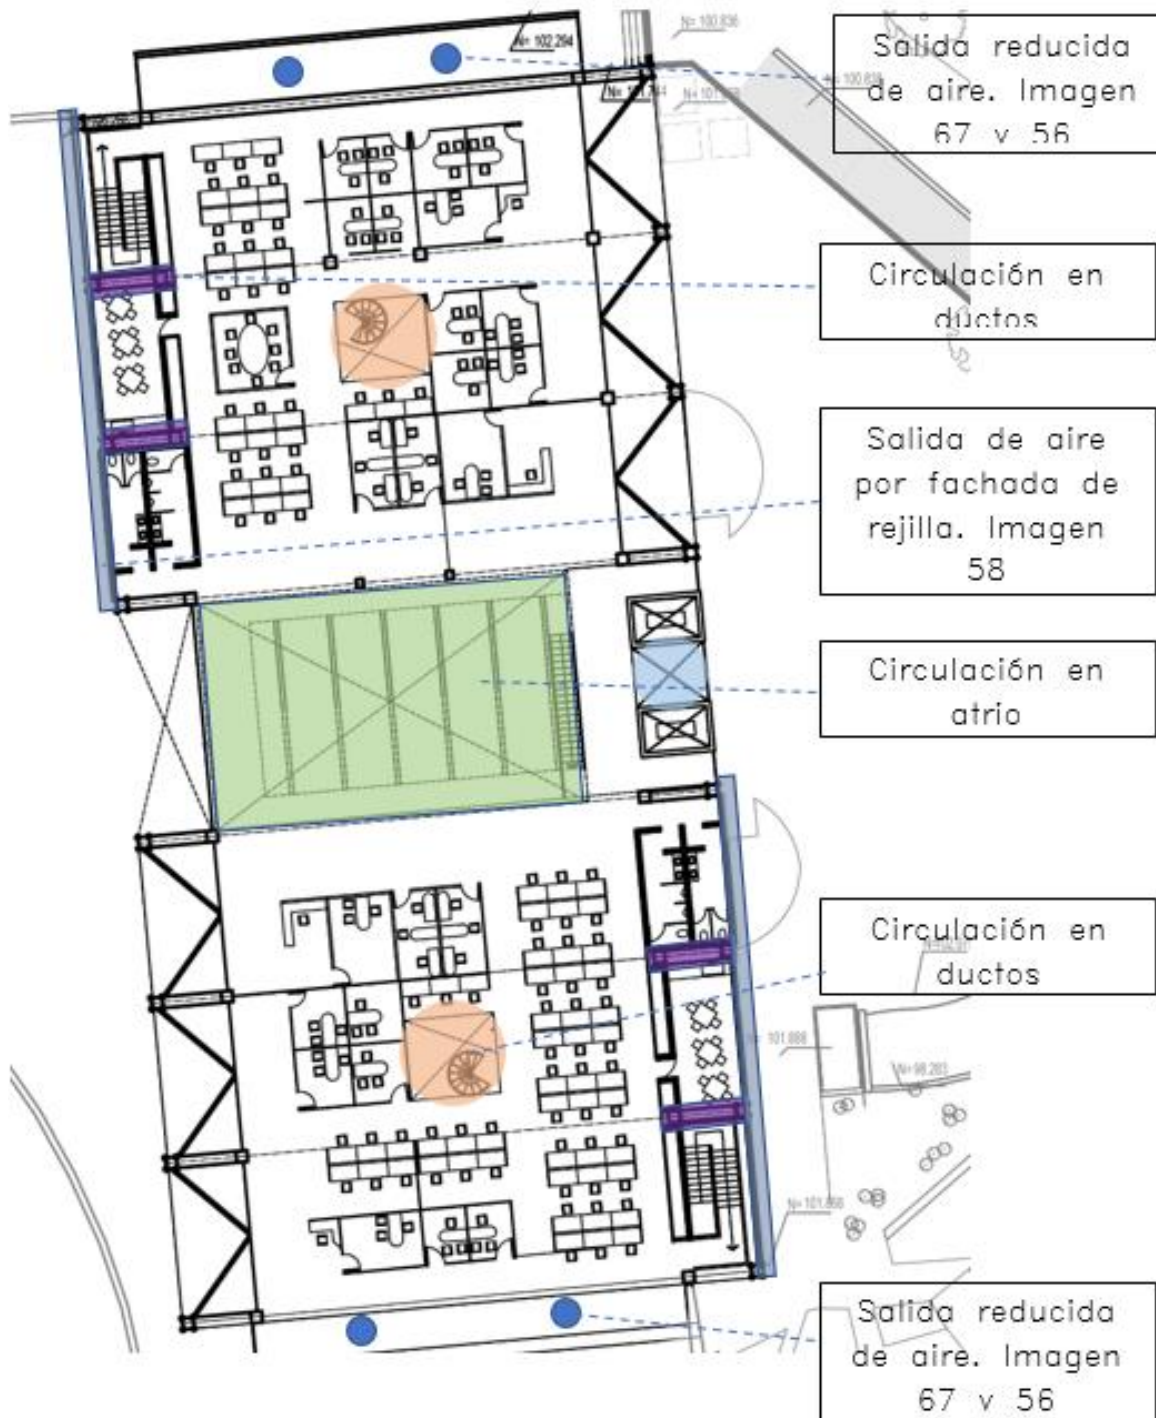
Circulaciones principales de aire en planta tipo. Elaboración propia
